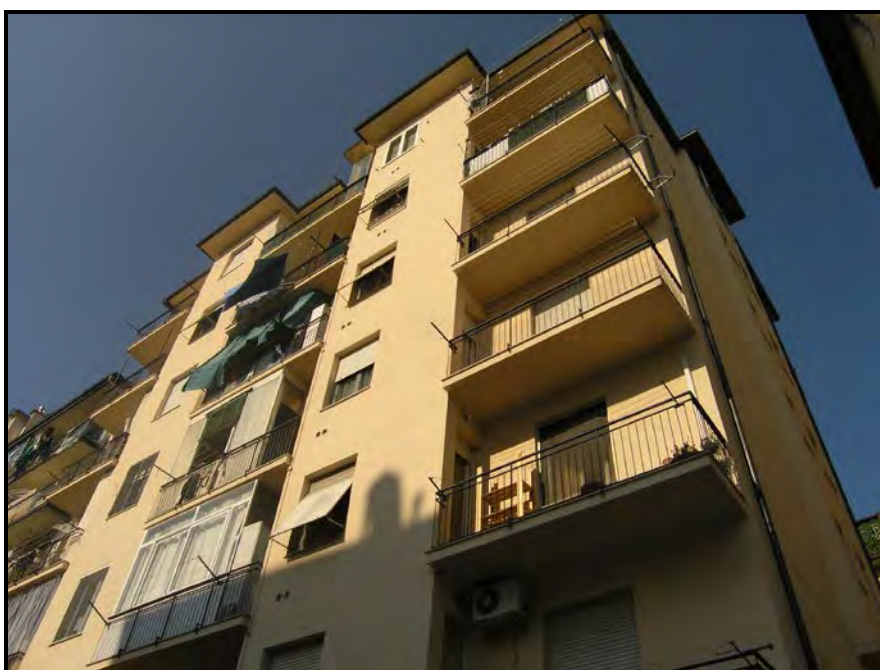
Prospettiva dal basso immobile via dell'Arcolaio 44A
